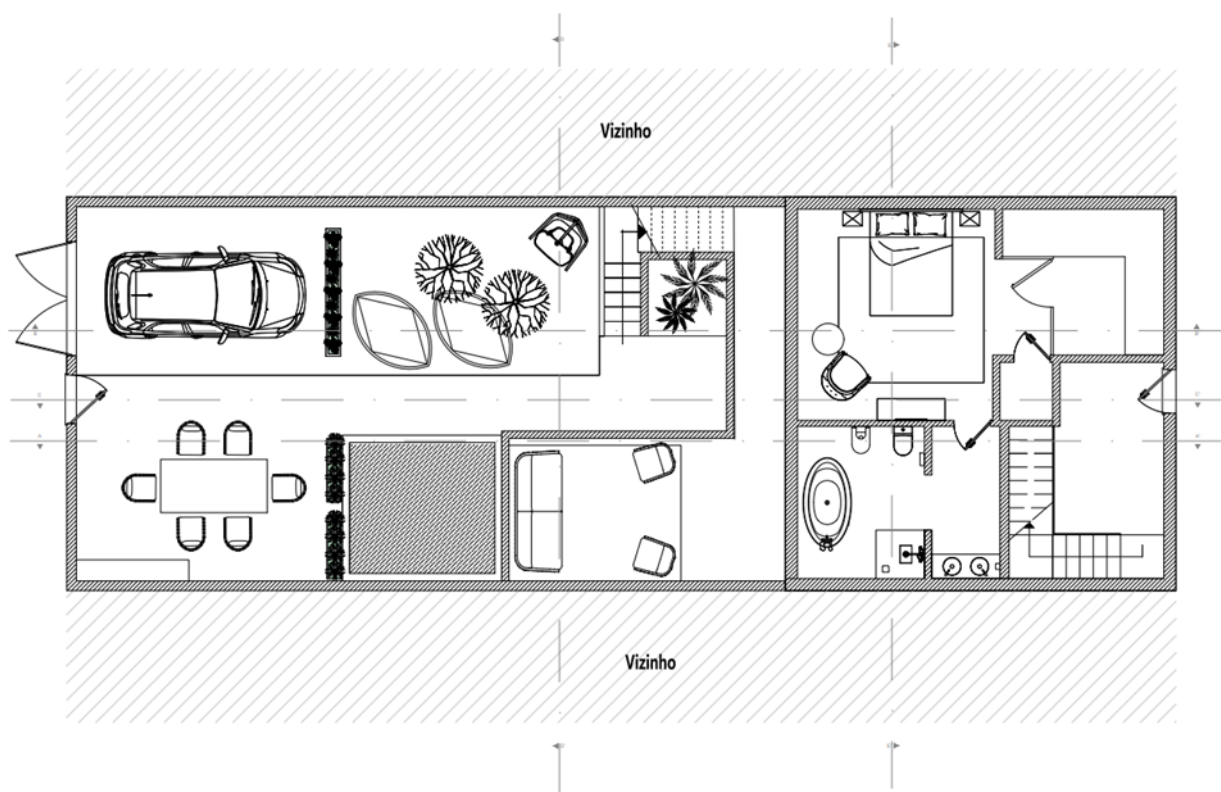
Planta de Apresentação, Piso 1, Sótão, Fonte: Autor
